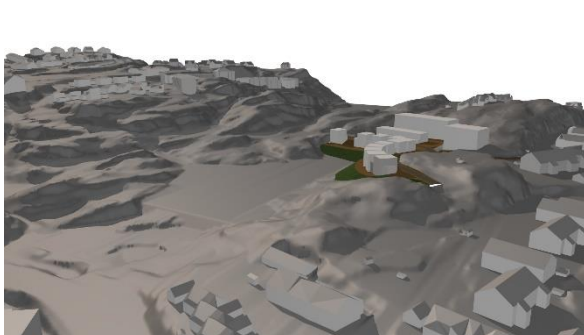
Modellbilde av alt. C2 sett fra nordvest
